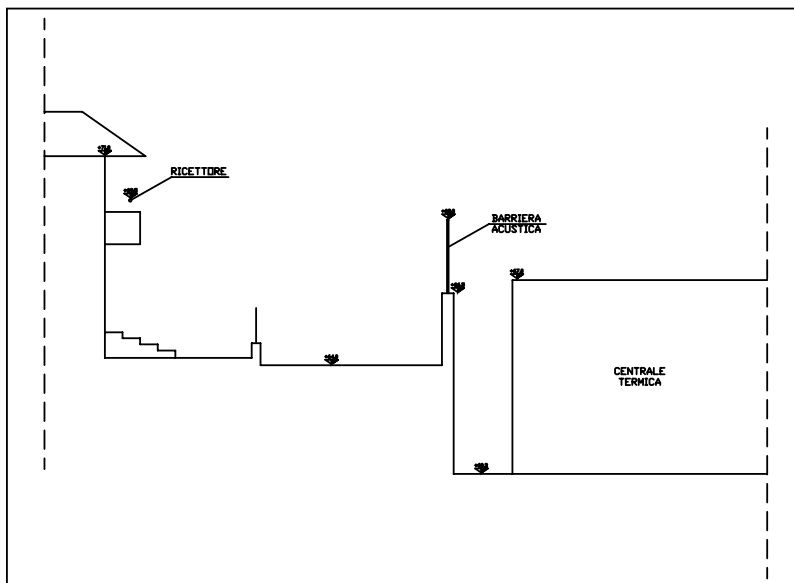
Sezione verticale in corrispondenza ad un ricettore
